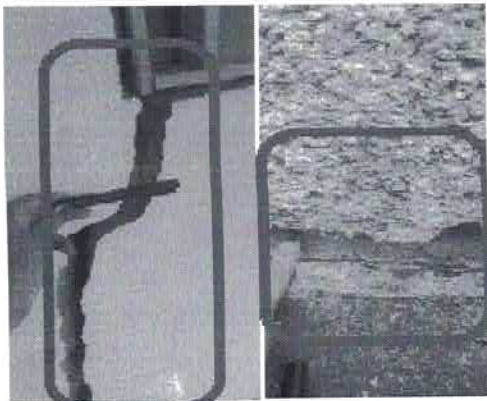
Imagens das trincas da parede frontal e da fundação.
